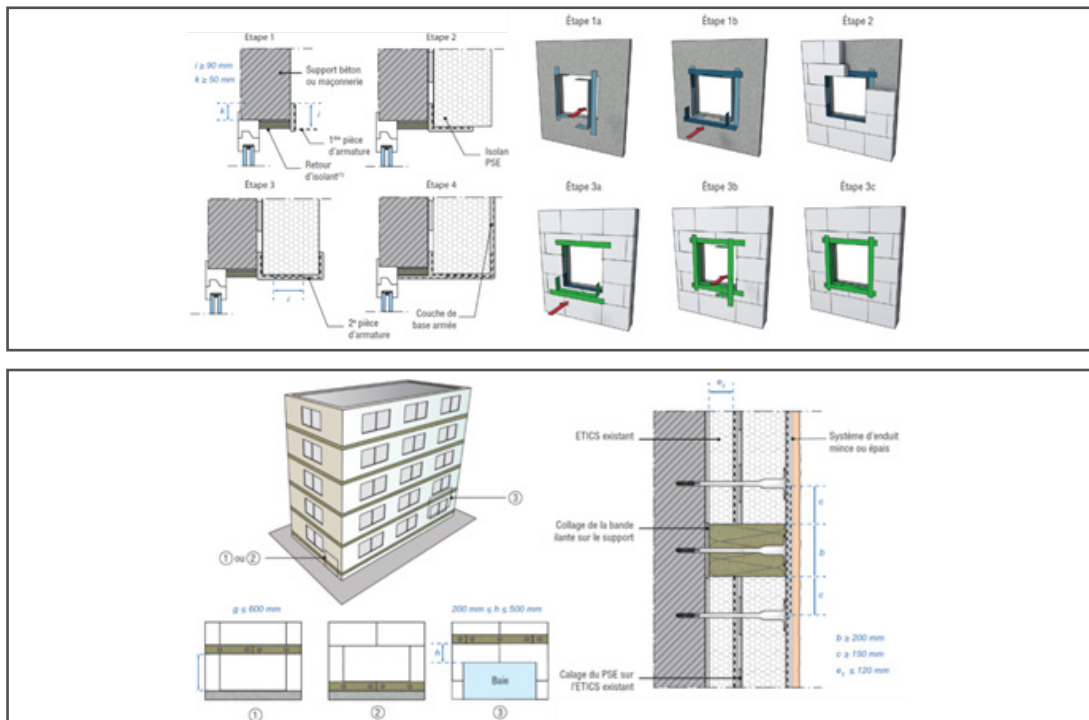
Detalles de aplicación de aislamiento SATE en Francia
